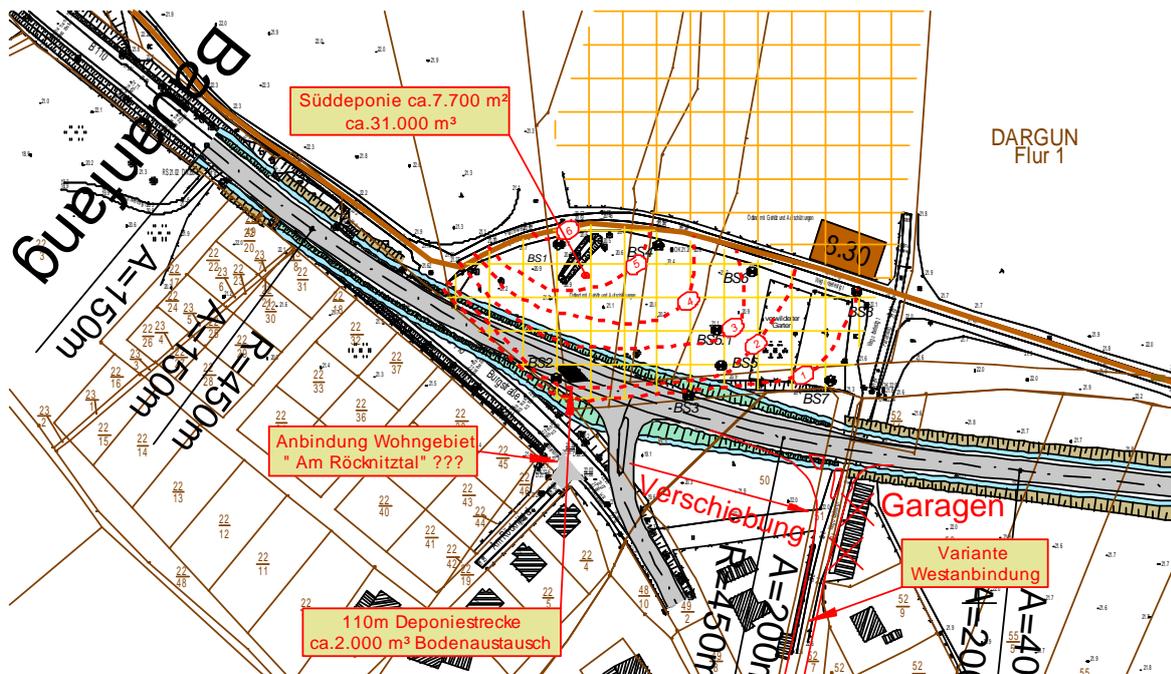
Trassierungsuntersuchung 1. Stufe „Trasse mit Minimalabstand zur Bebauung“(Variante 5.1)
